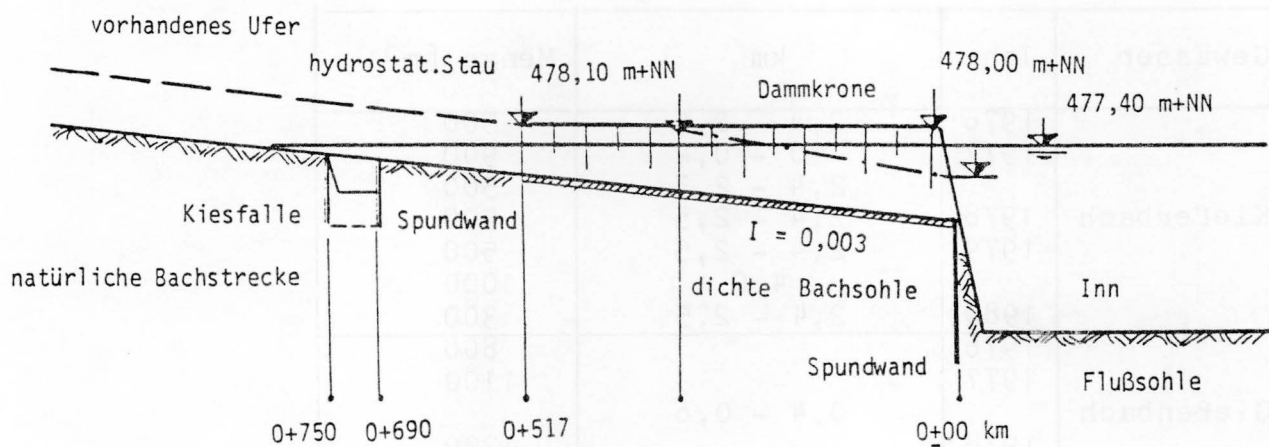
Längsschnitt der Mündungsstrecke des Kieferbaches (geplant)
